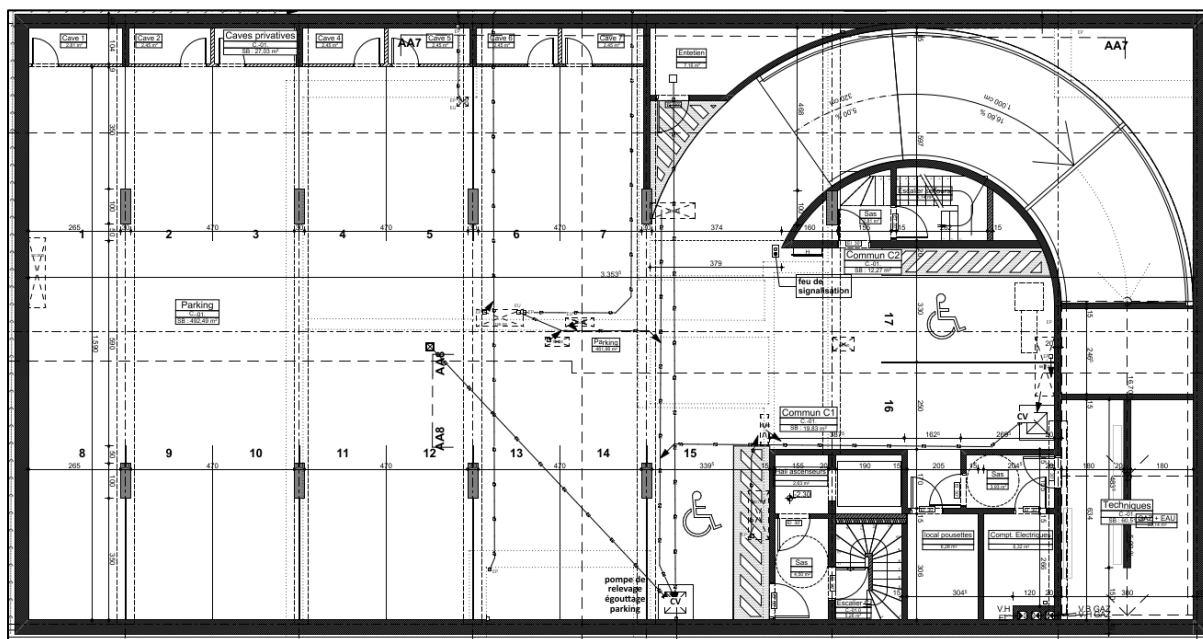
Parking souterrain du bâtiment 2 (source : Plans PU)
